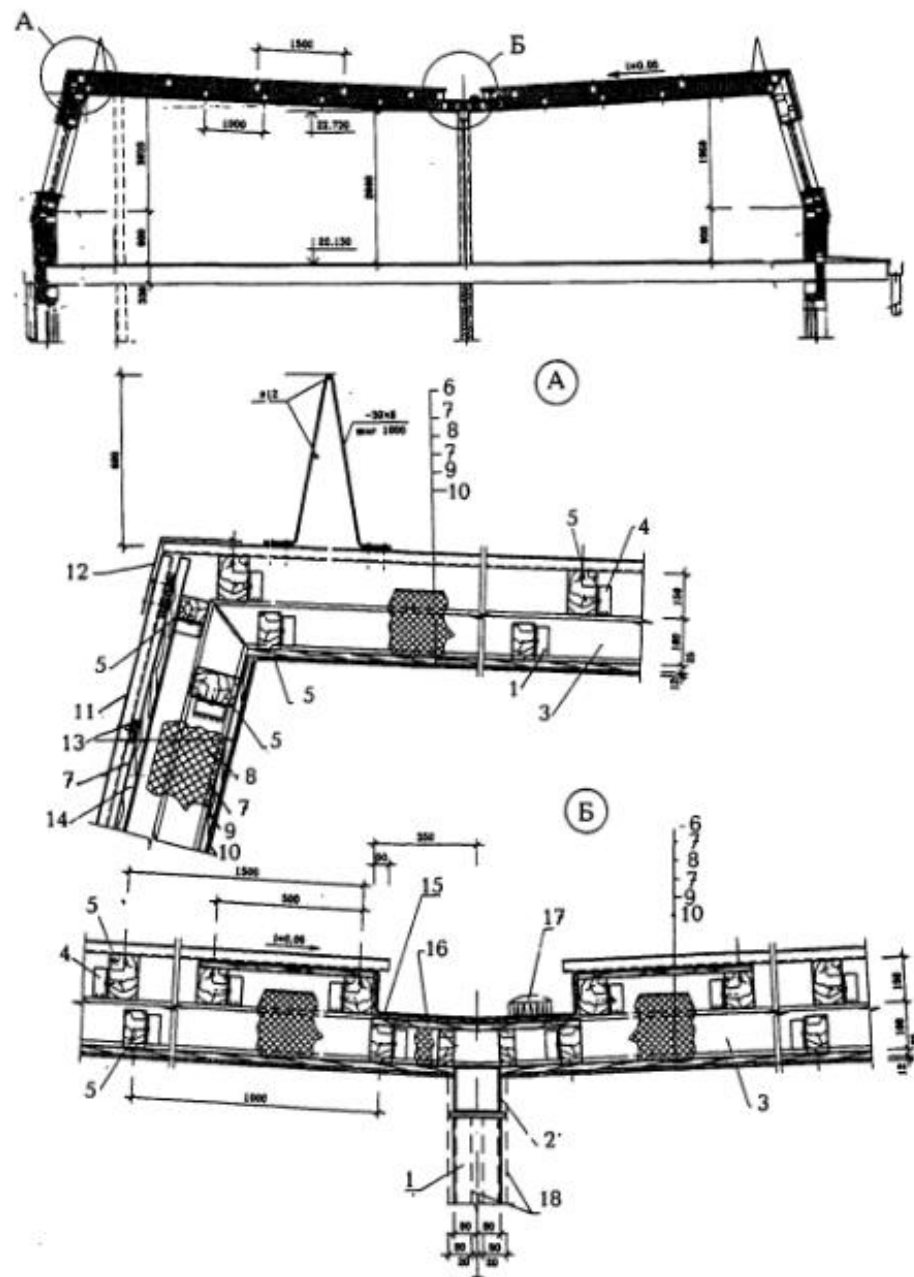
Одноэтажная бесчердачная мансарда с металлическим каркасом и внутренним водостоком: 1 – стойка из стальной трубы квадратного сечения 160x160x5; 2 – стальная балка того же сечения; 3 – стальная сварная стропильная рама из двутавра № 16; 4 – стальной уголок 50x5,  $t=100$  для крепления деревянных прогонов под кровлю и под внутреннюю обшивку; 5 – деревянный прогон; 6 – профилированный настил; 7 – защитная пленка; 8 – утеплитель  $\lambda=0,04$  Вт/м<sup>2</sup>С; 9 – доски обрешетки шагом 250 мм; 10 – гипсокартон; 11 – металлочерепица; 12 – металлический фартук; 13 – дощатая обрешетка; 14 – контробрешетка; 15 – лоток из оцинкованной стали; 16 – сплошной дощатый настил; 17 – водоприемная воронка; 18 – гипсокартонная перегородка
